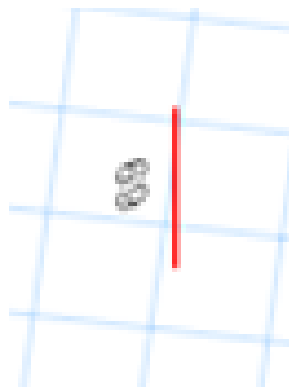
Фрагмент армирования колонны на отм. 0.000м до отм. 4.95 м по оси 4/а (площадь полной арматуры)
